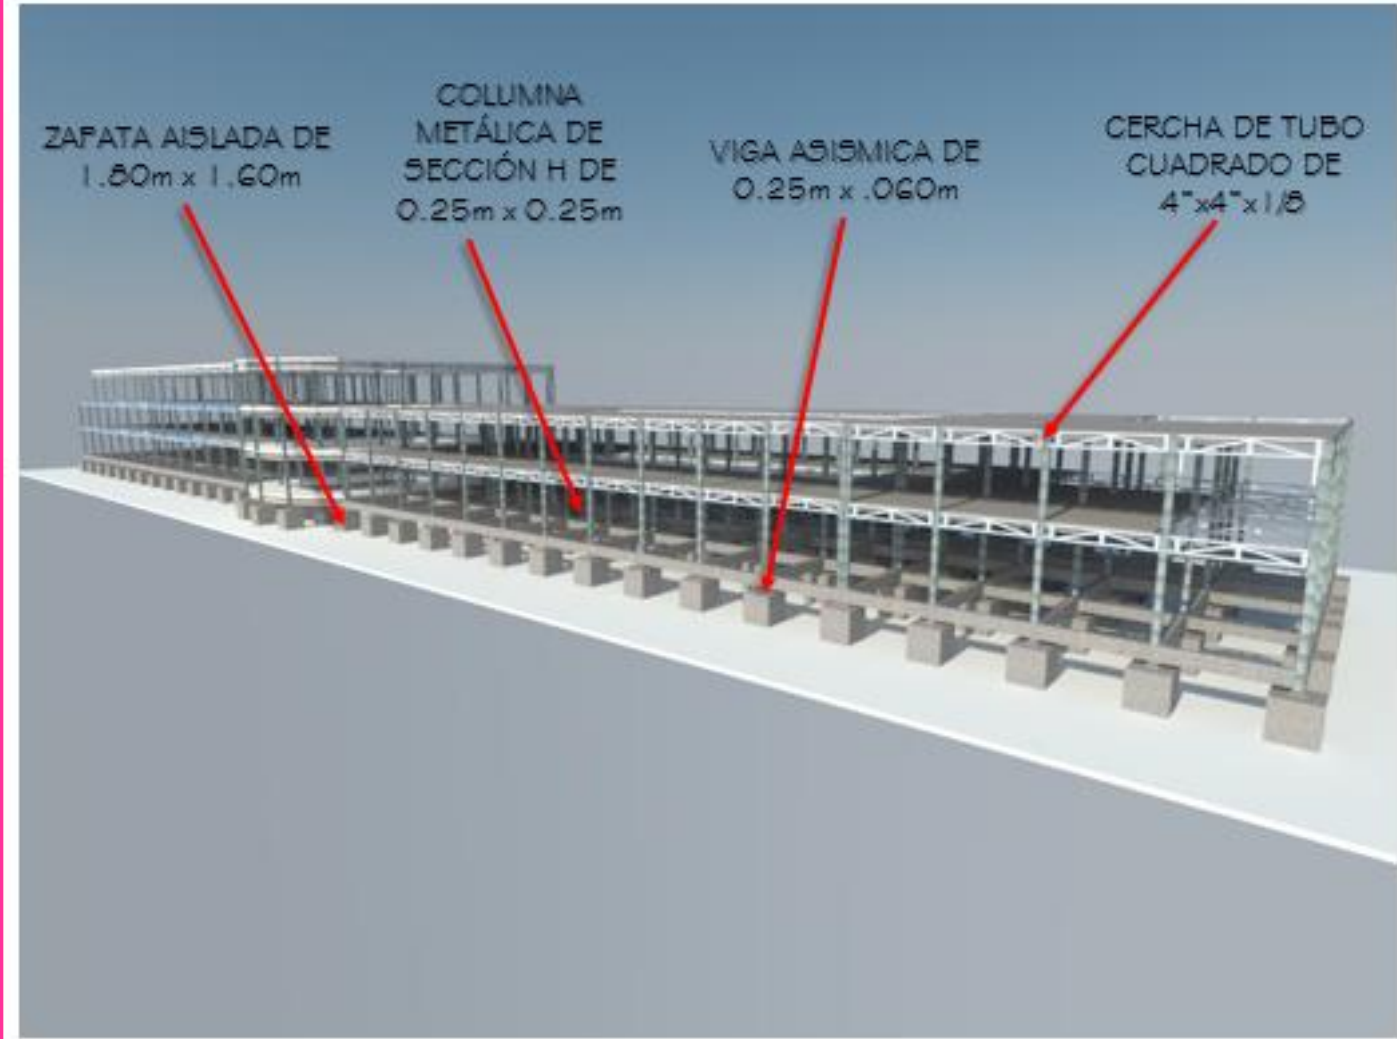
Perspectiva 3D de esqueleto estructural
